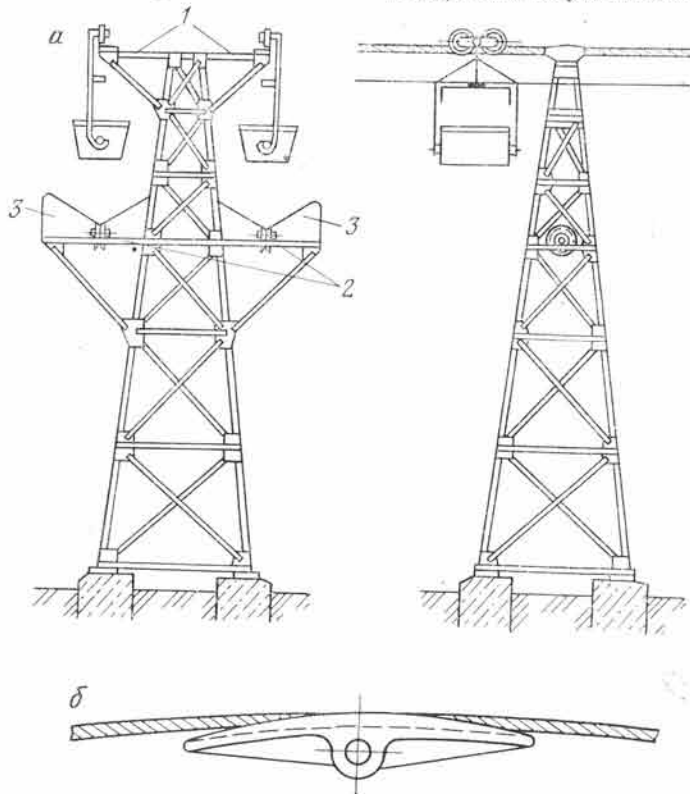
Металлическая опора на бетонном фундаменте (а) и башмак для поддержания несущего каната (б)
